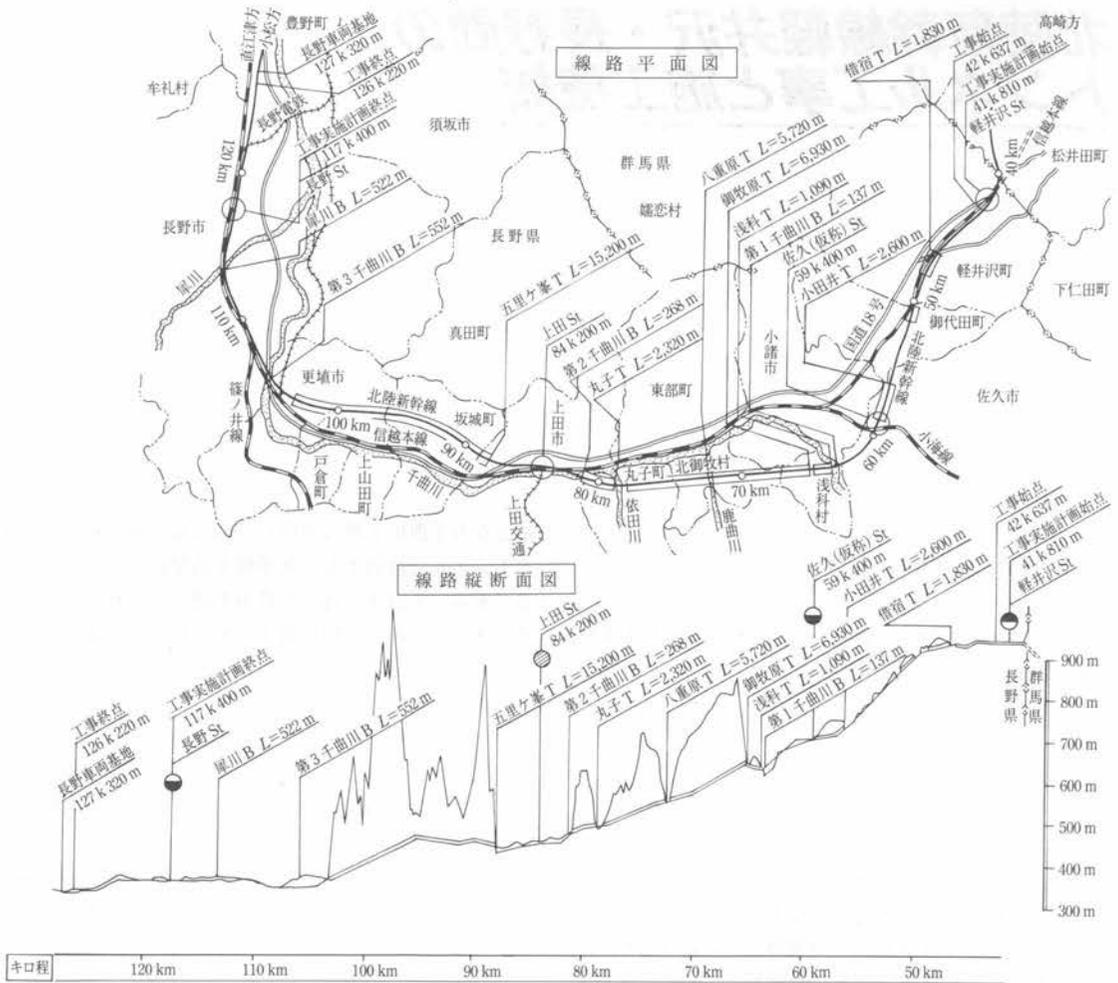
北陸新幹線(軽井沢・長野間)線路平面縦断略図
